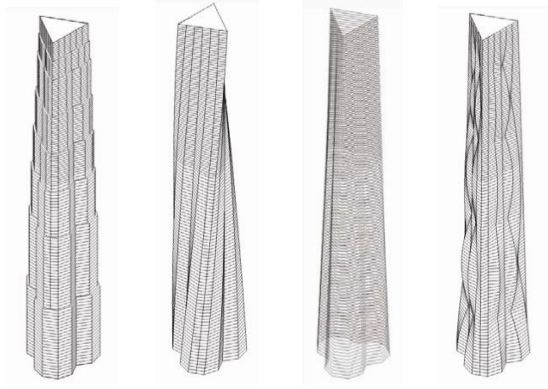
Plan şemaları açısından çokgenlerden türetilen simetrik formlar [21]
